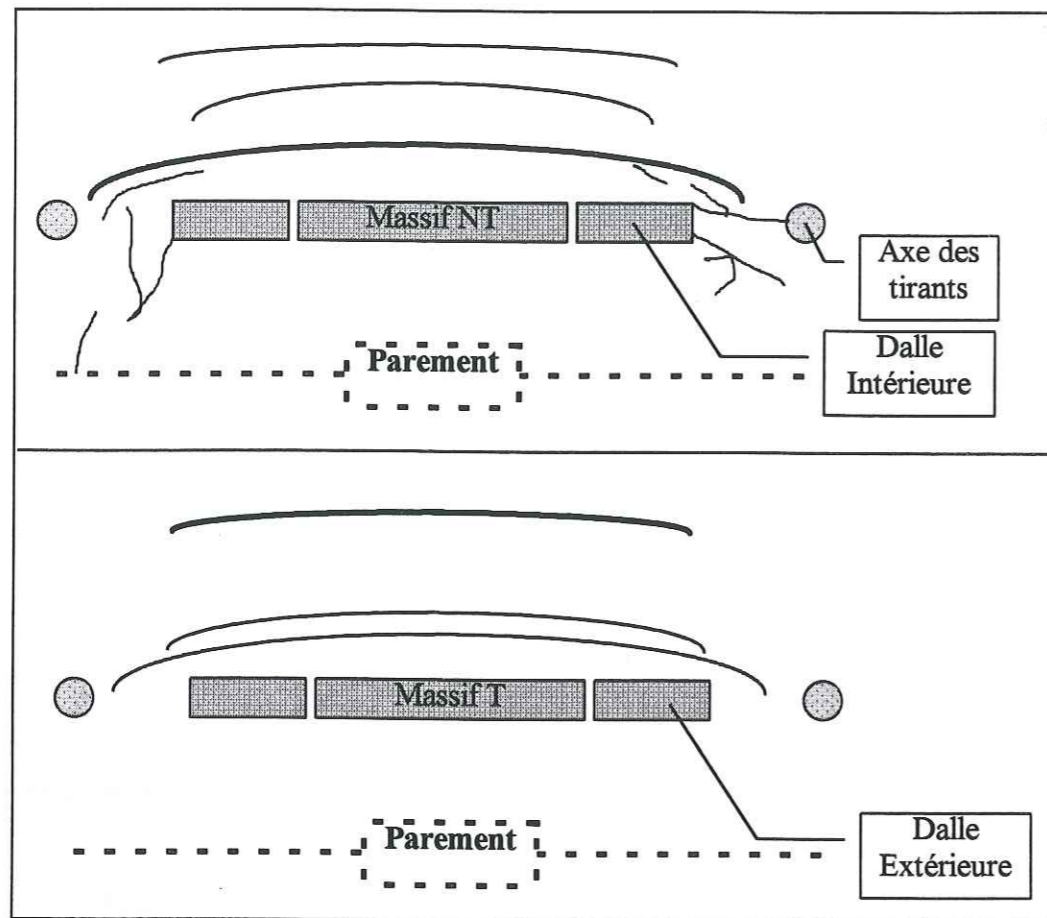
Schéma des fissures autour des dalles de chargement en fin d'essai
